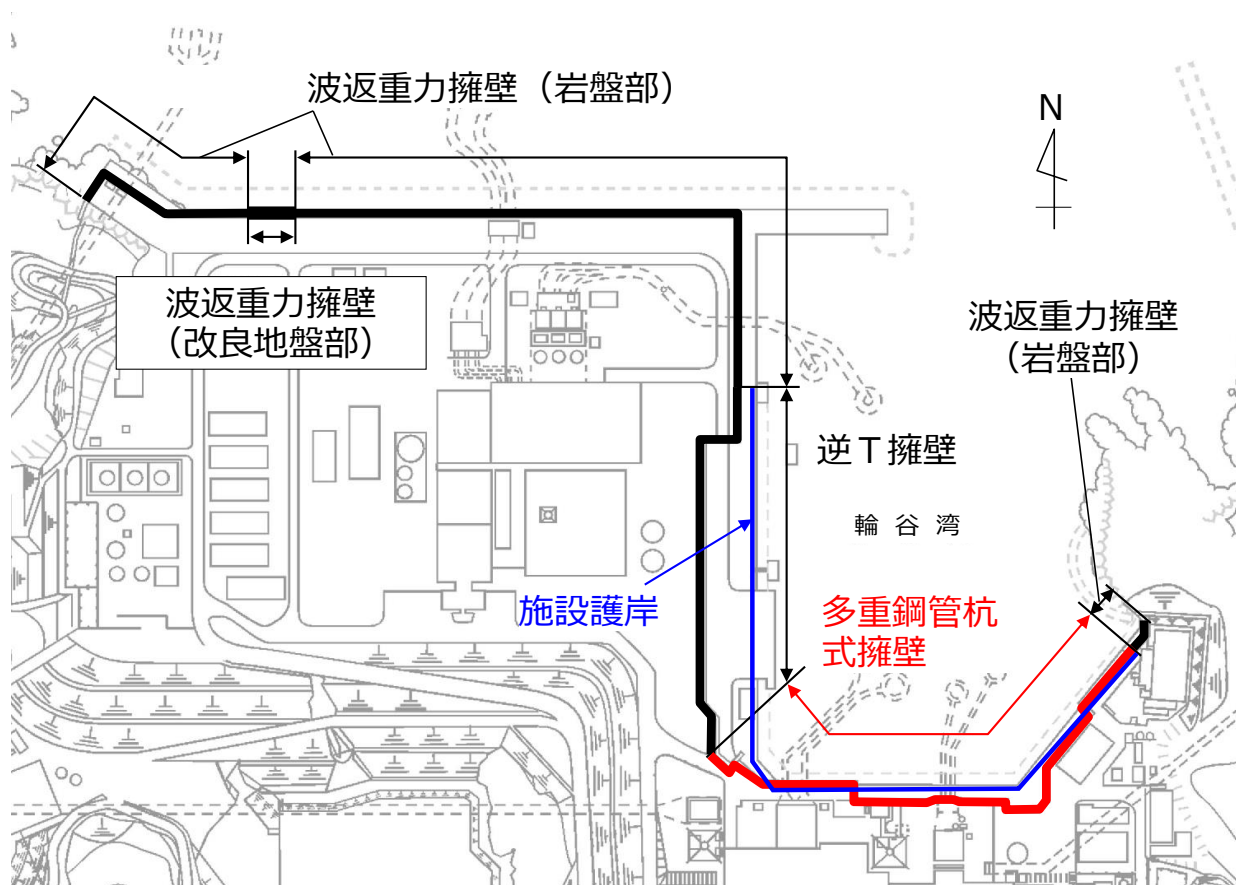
防波壁と施設護岸の配置（全体平面図）
